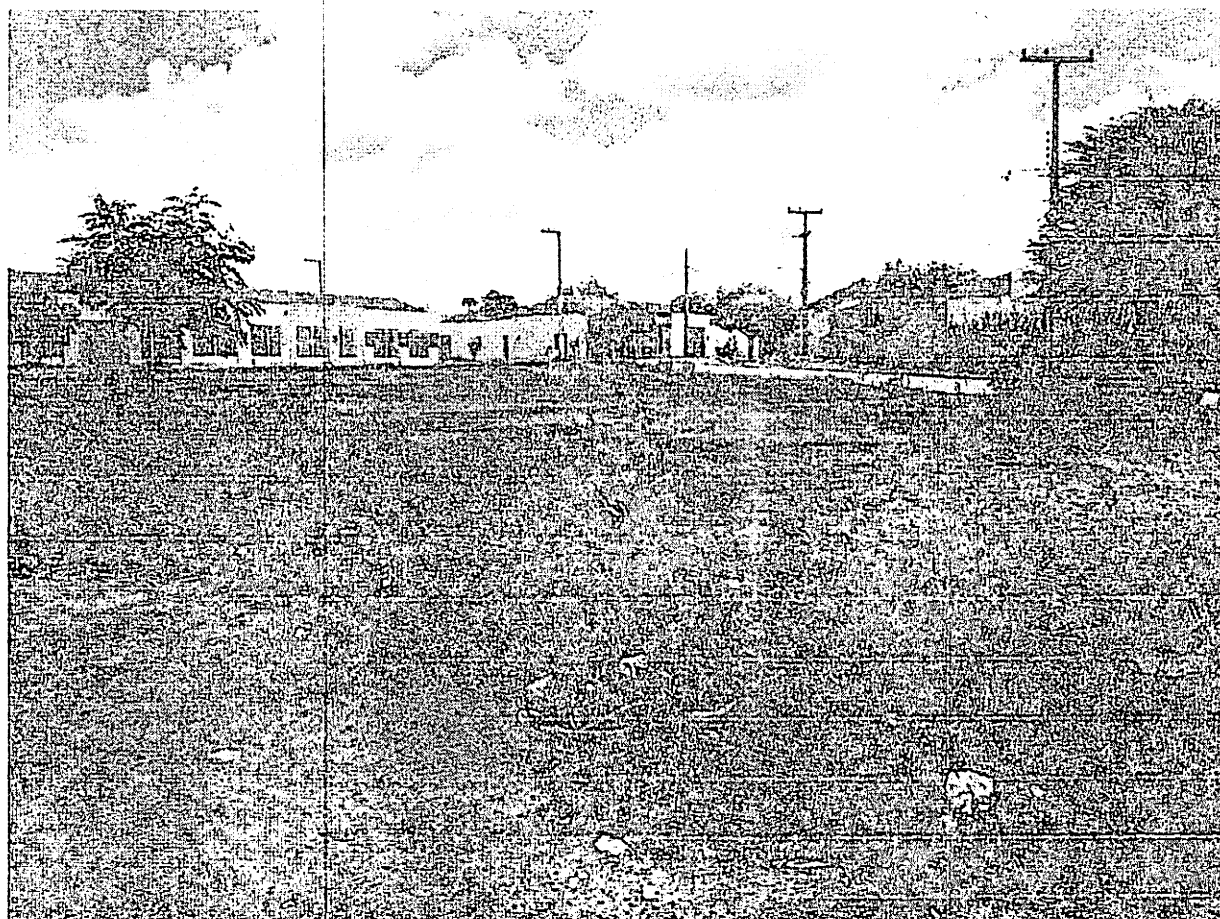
Área do terreno para construção da praça do Bairro Mutirão.
